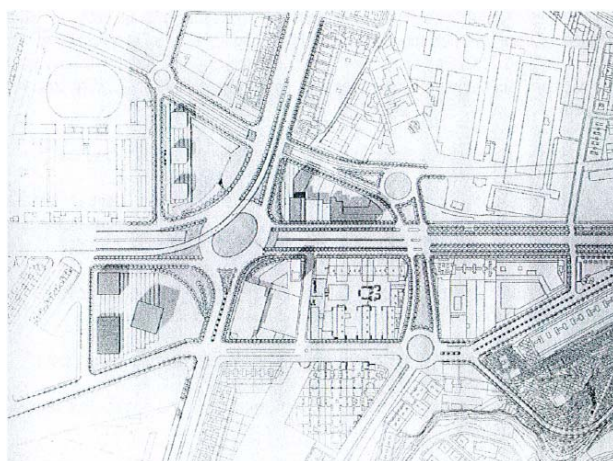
Propuesta constructiva para la Plaza Cerdà antes de la solución final
